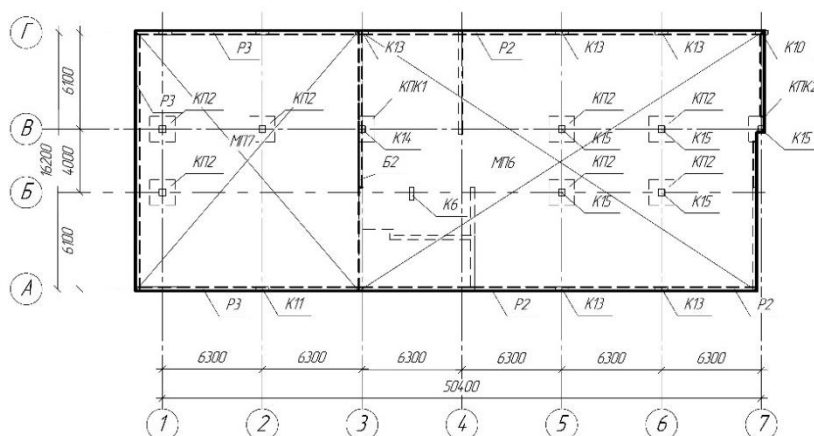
Схема монолитных ж/б колонн, плит перекрытий, капителей и ребер второго – седьмого этажей
